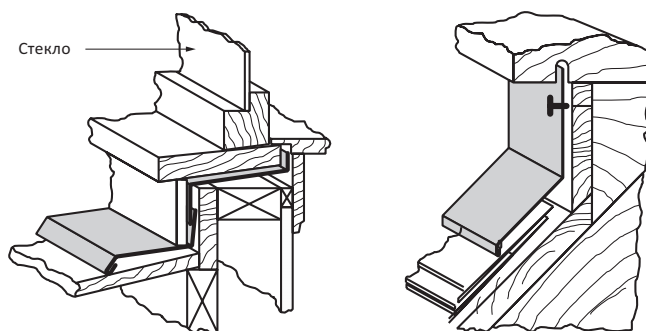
Два примера укладки нижнего слоя гидроизоляции под подоконником слухового окна.
